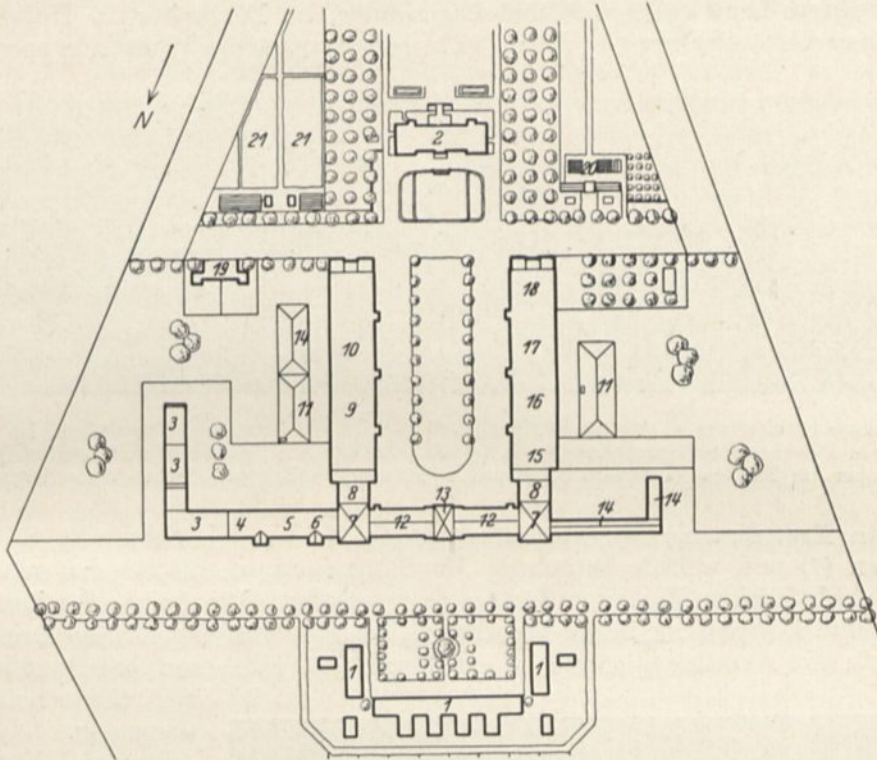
Gutshof Hahnenmoor bei Hannover. Grundriß. (Ausführung: „Zementbau“, Ges. für Bauausführungen m. b. H., Hannover.)
